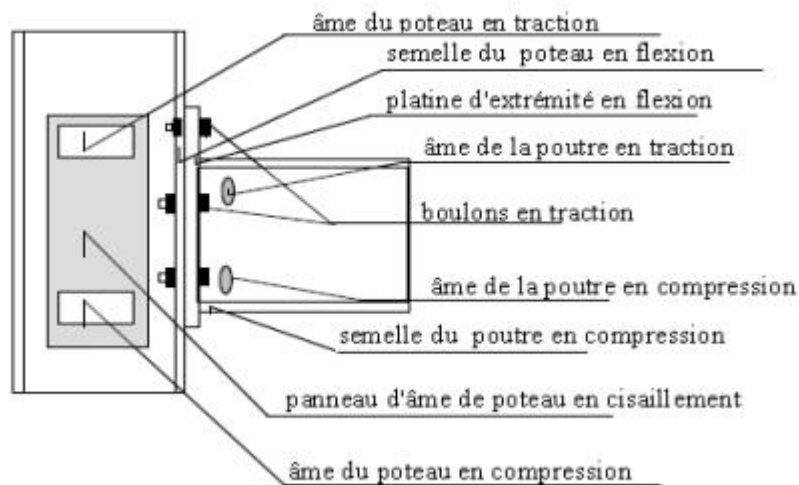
Composantes de base de l'assemblage par platine d'about boulonnée [51]
